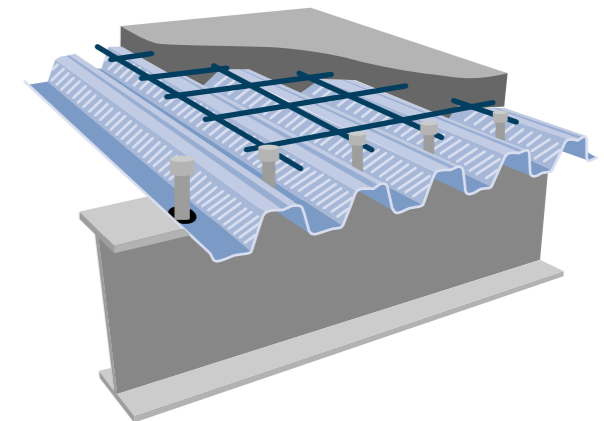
Plancher collaborant avec goujons soudés
